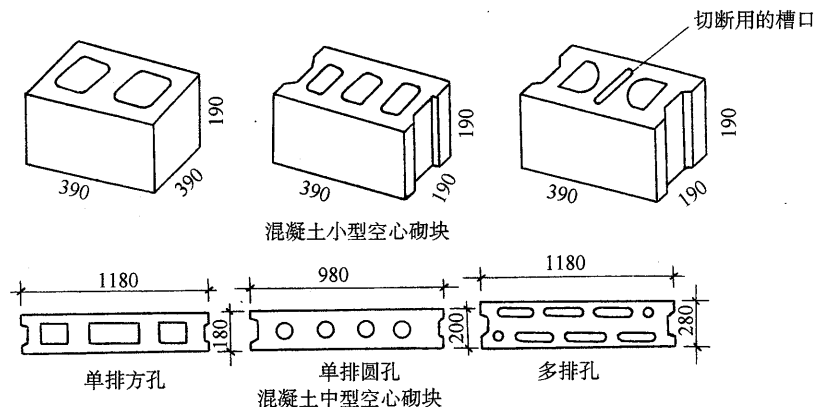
混凝土中、小型空心砌块 (单位: mm)
